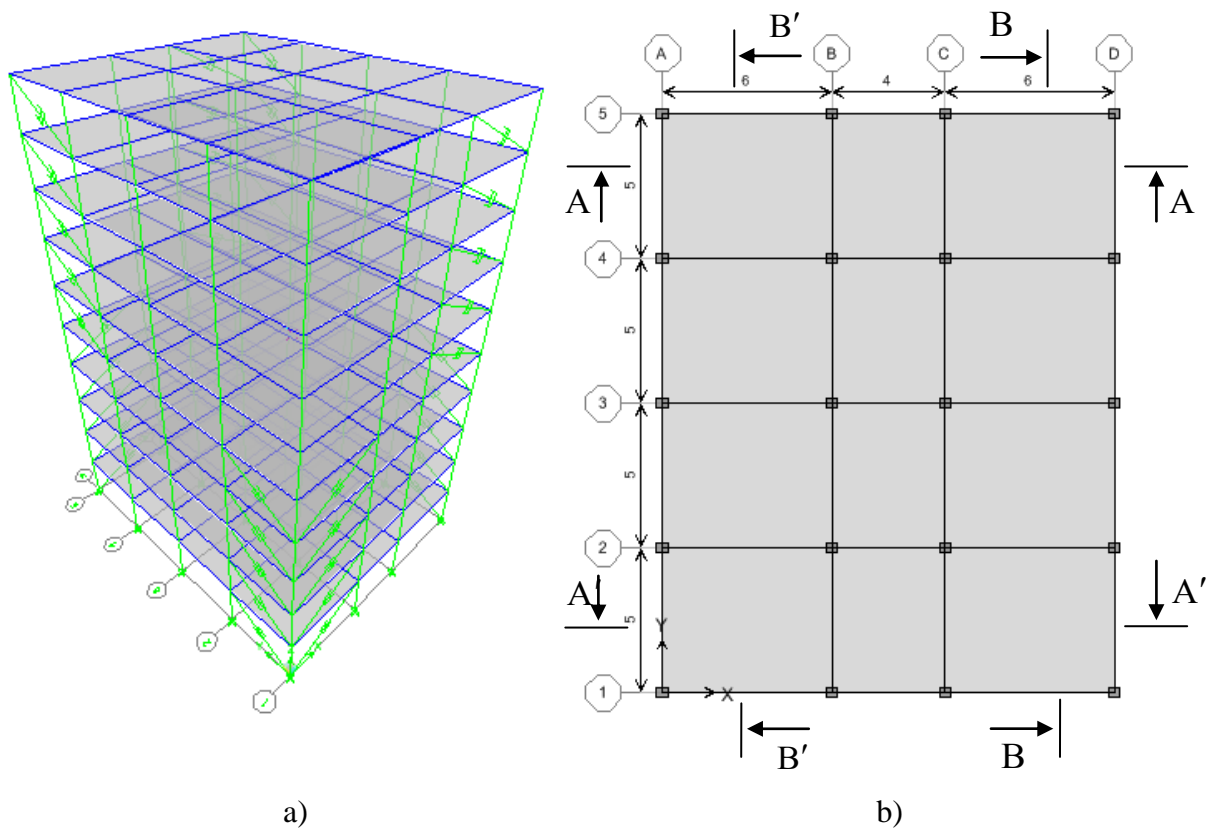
Troisième proposition de la structure : a) vue en 3D b) vue en plan
